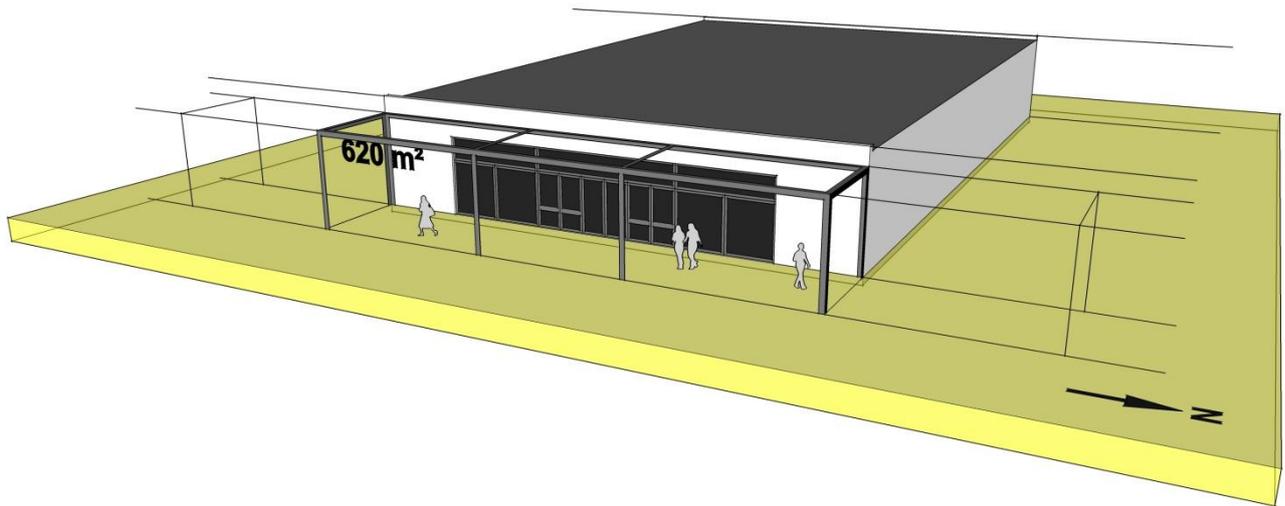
Verbrauchermärkte - Kombimodul Non-Food – Darstellung Gebäude – Ansicht Nord-Ost
